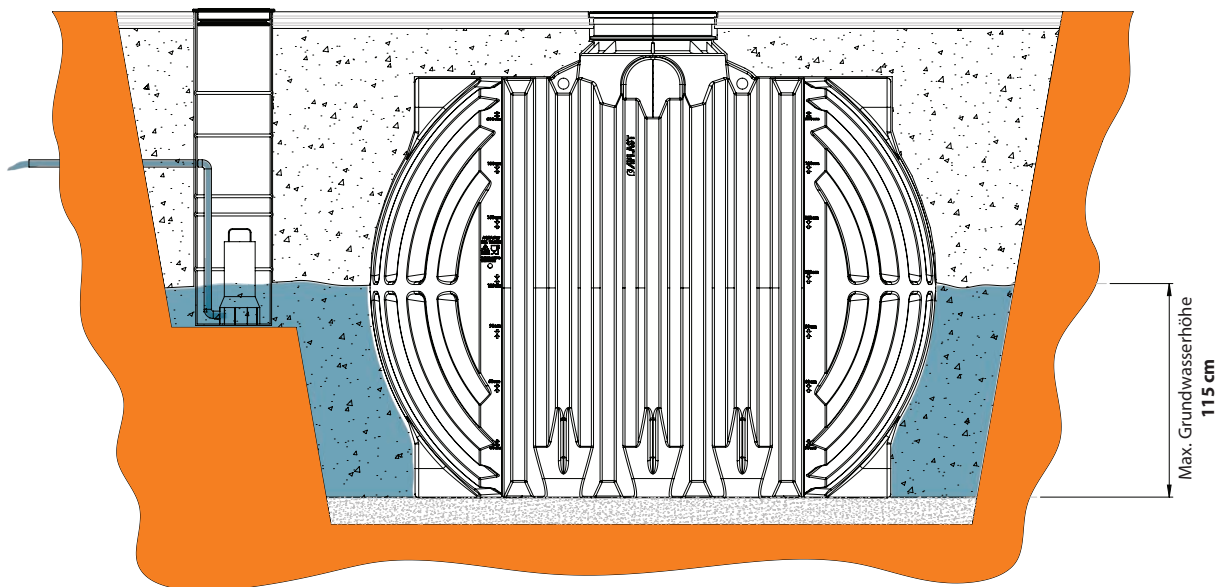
Einbaubeispiel des Behälters in Bereichen mit vorhandenem Grundwasser
